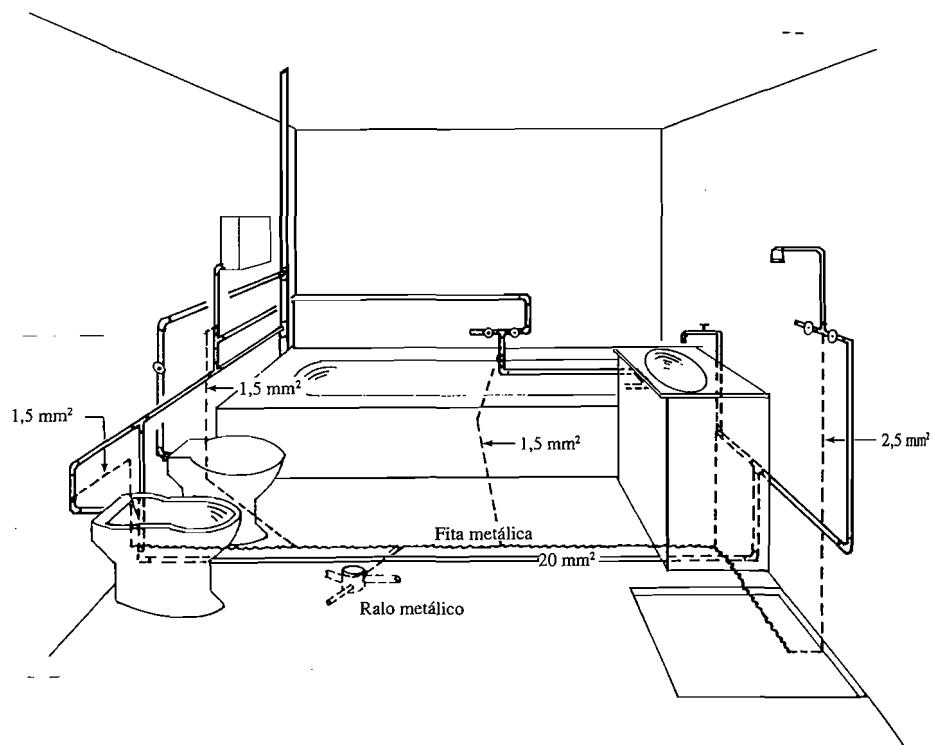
Ligação equipotencial em um banheiro, com tubulação metálica (cobre, por exemplo)
